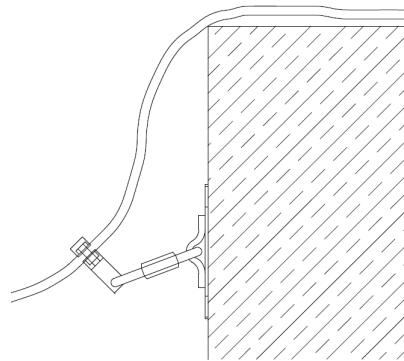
Kabelbefestigung mit Klemme und Schnellverbinder
